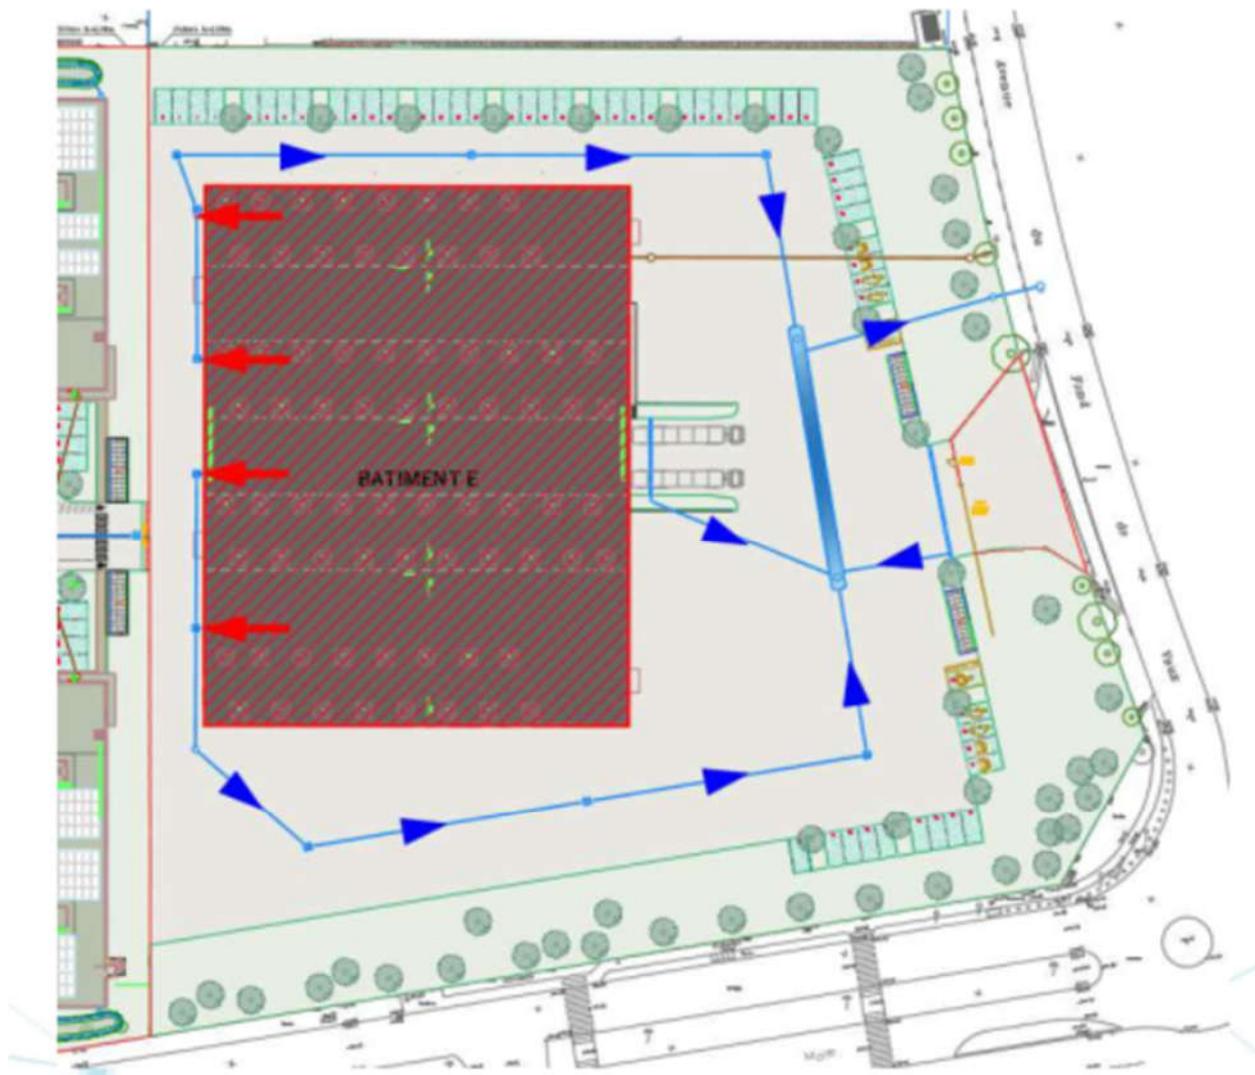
Plan de gestion des eaux de toitures du projet SNC SH SOA
